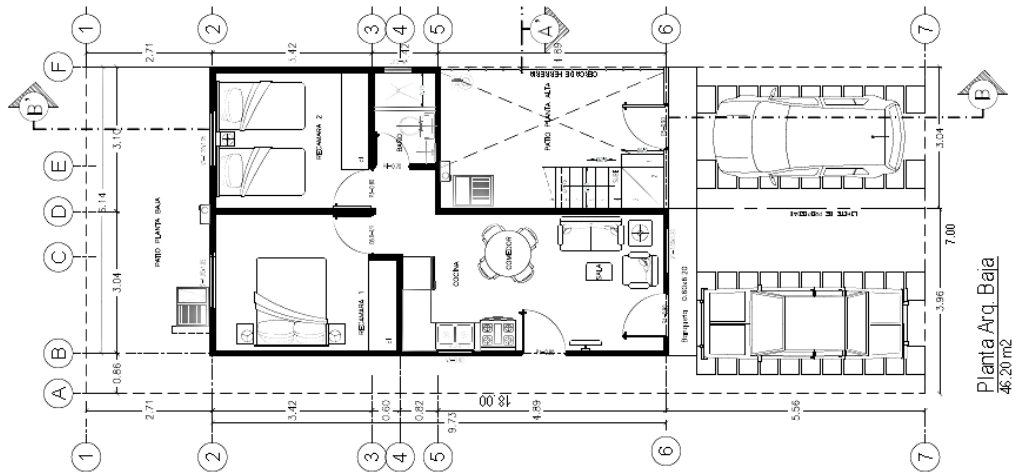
Planta baja arquitectónica del modelo verona plus, fuente: Registro Único de Vivienda
